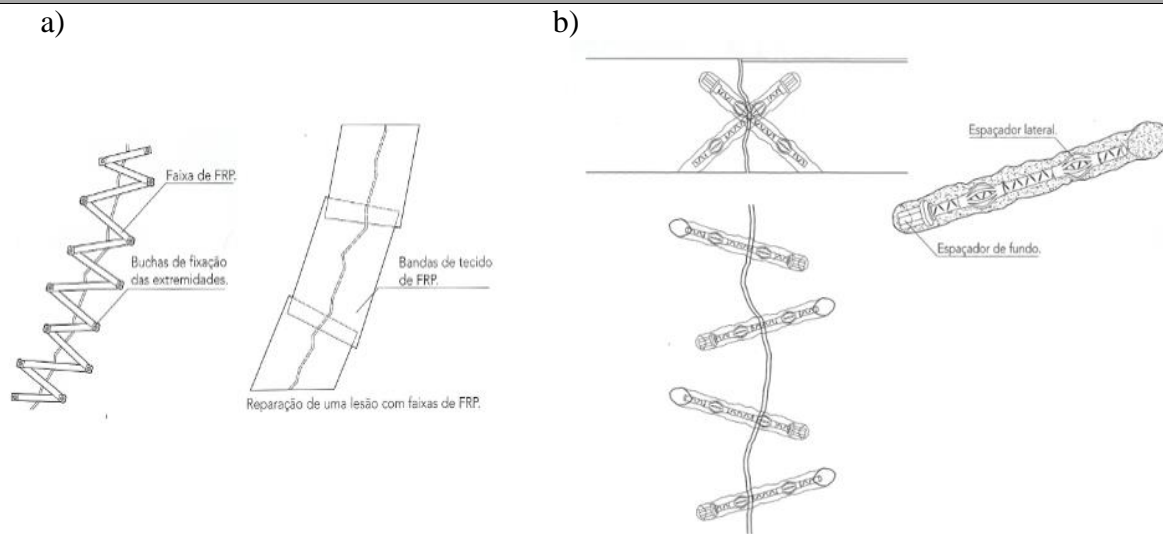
Fissuras (Adapt. [33]): a) Reparação com faixas de FRP; b) Reparação com aplicação de espaçadores
